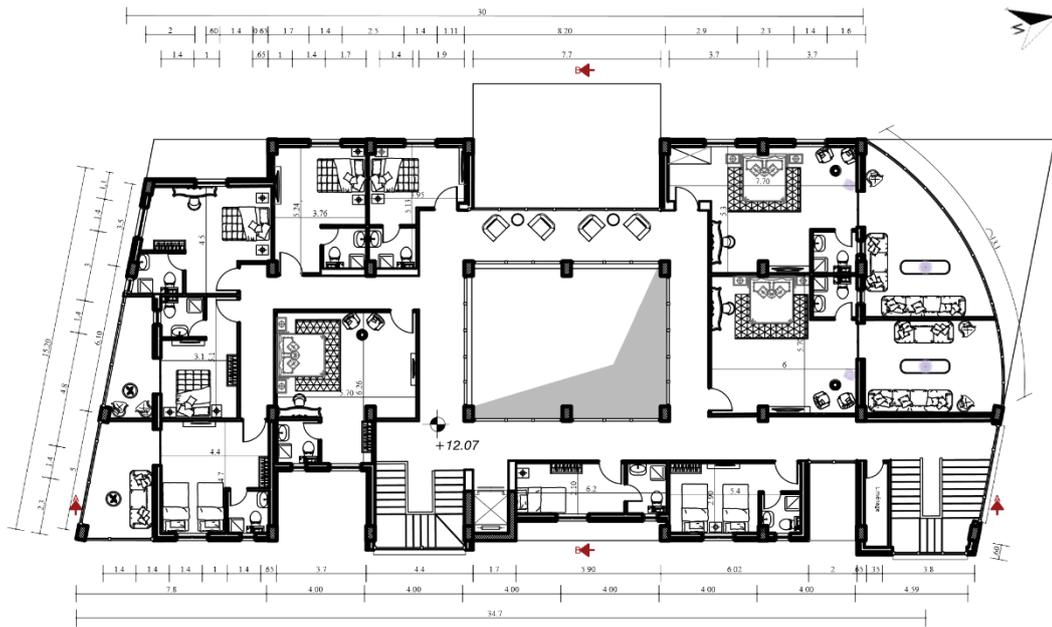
Plan de RDC 1/300 Sr : dessiner par auteur
